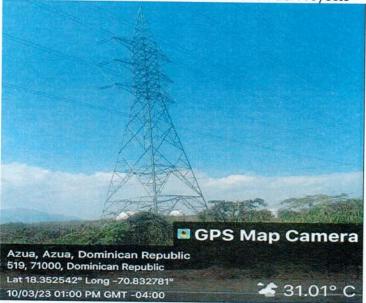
Vista Panorámica de las Facilidades del Proyecto
